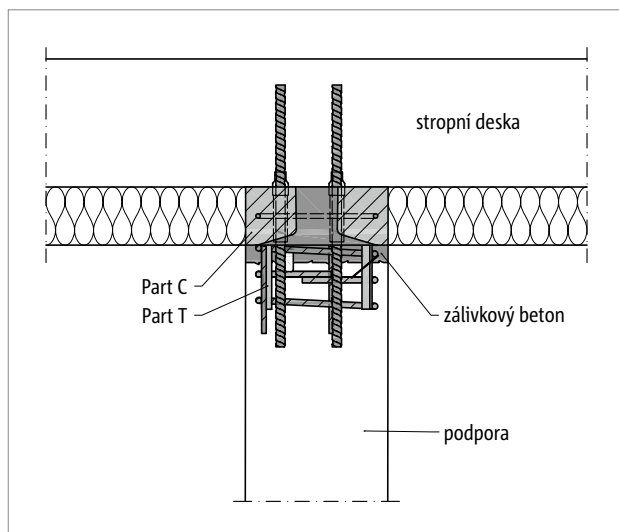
Schöck Sconnex® typ P: Napojení hlavy krajního sloupu na strop
